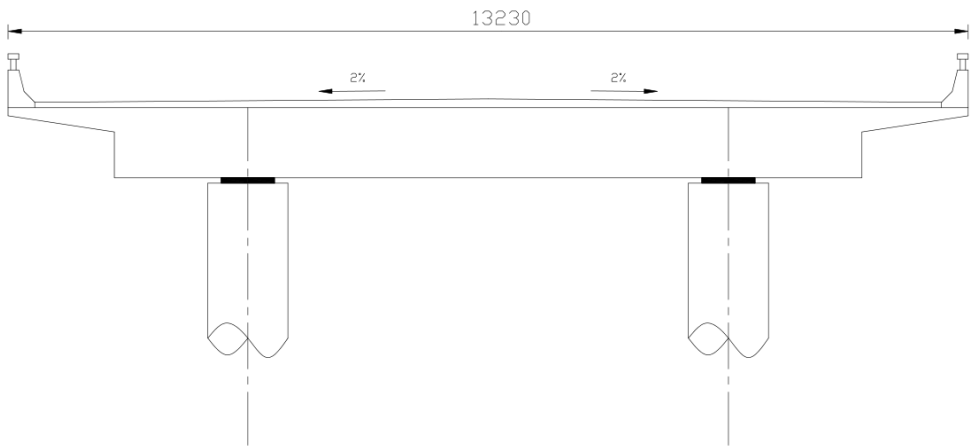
琵琶王立交桥东环 DD 桥-梁端截面图（单位：mm）
